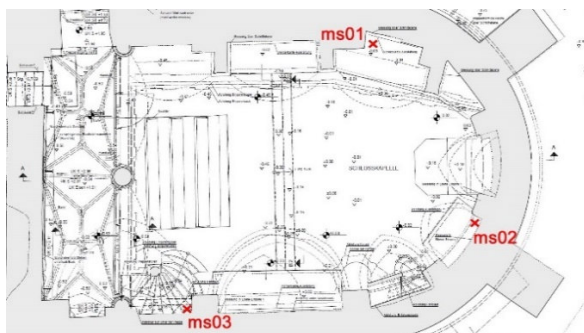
Referenzflächen im Erdgeschoss (Grundrisspläne SBLH 2016)
